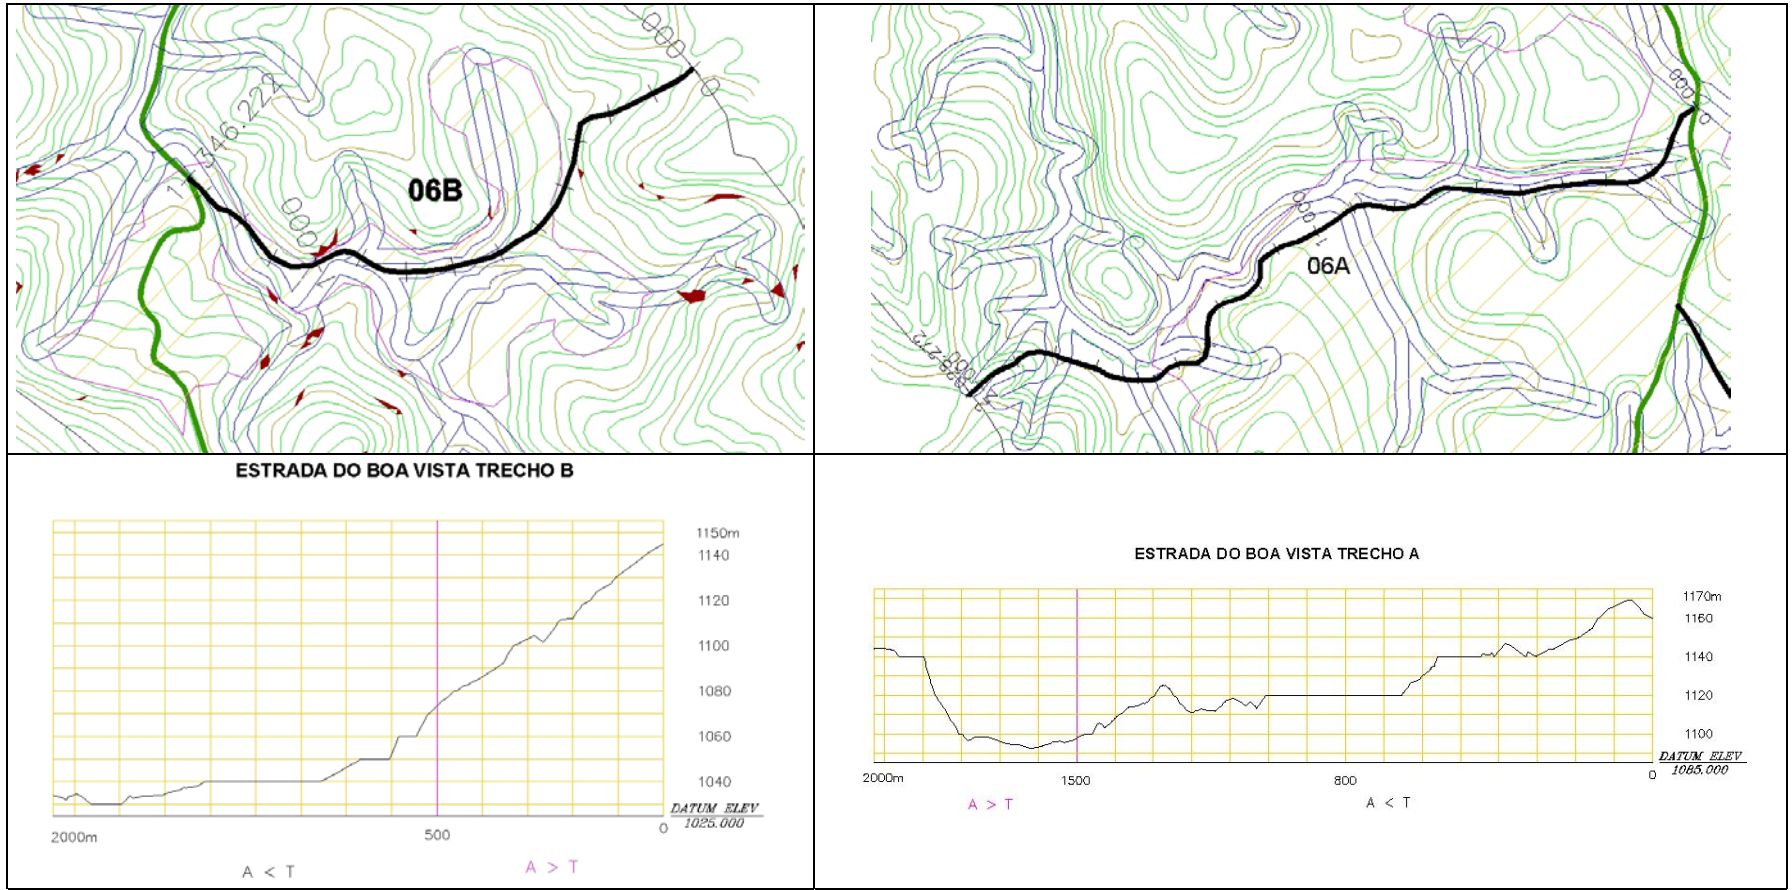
Planta e Perfil Topográfico da Estrada do Boa Vista Trechos A e B – 06A (MB5) e 06B (MB6)
